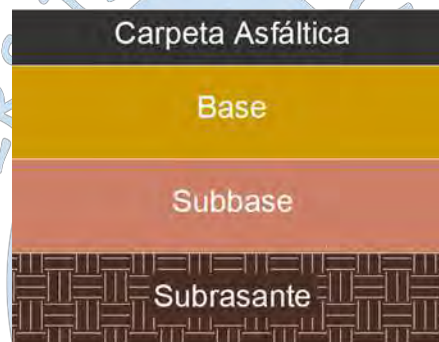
Detalle del paquete estructural para pavimentos flexibles.
